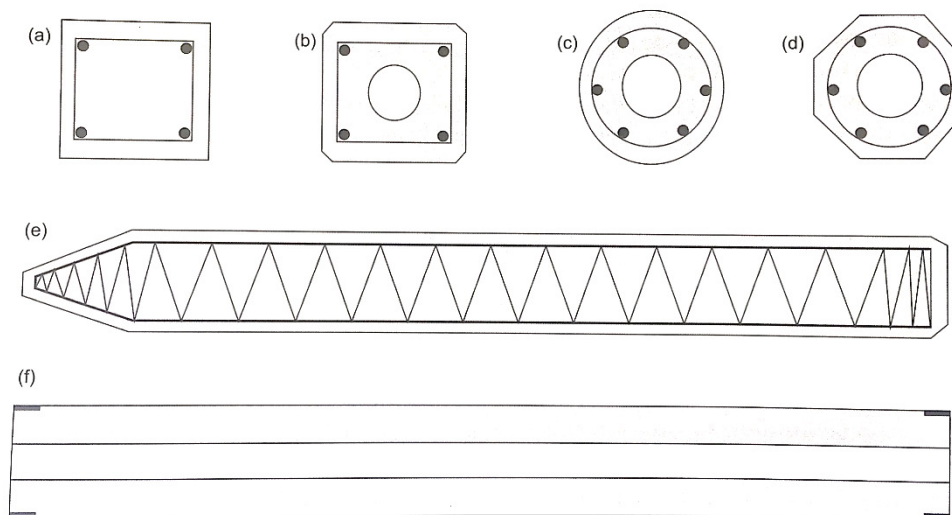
(a) à (d) seções transversais;(e) seção transversal com armadura típica; (f) estaca com furo central e anel de emenda (Fonte: VELLOSO e LOPES, 2010)
